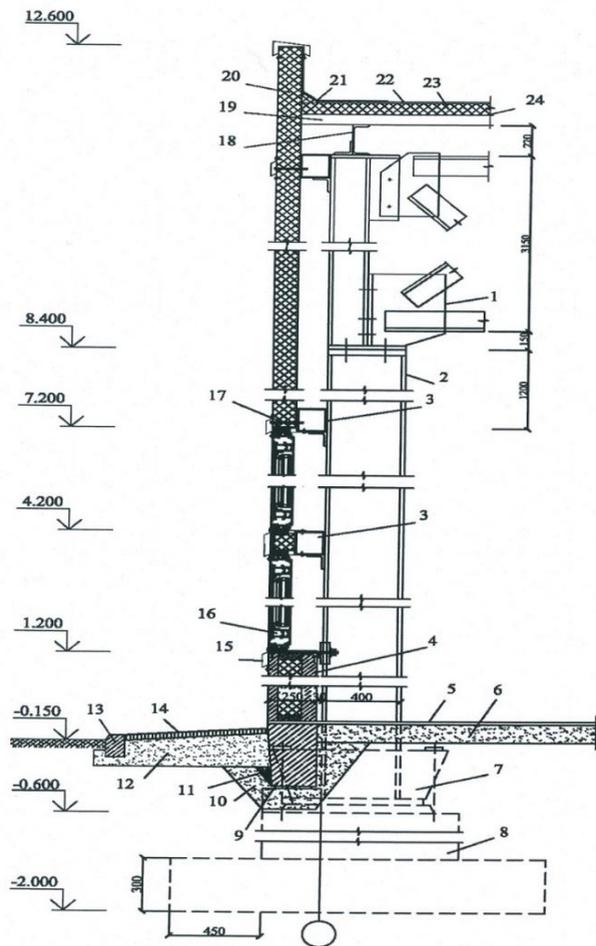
Пример схемы вертикального разреза по наружной стене производственного здания из панелей типа «сэндвич» вертикальной разрезки:
